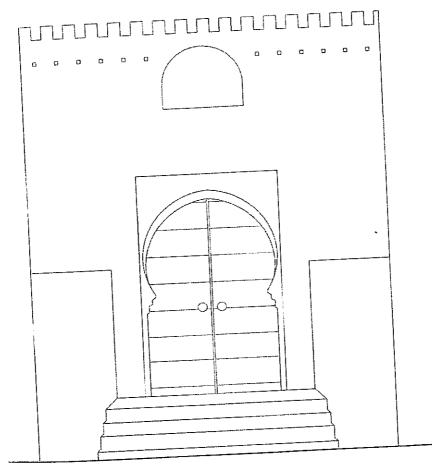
مسقط أفقي كروكي لبوابة ساحة الفرسان، عمل الباحث.
